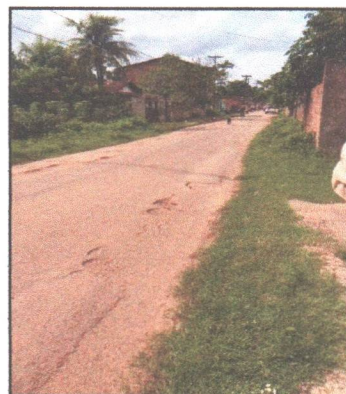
Imagem da rua de acesso ao imóvel com pavimentação asfáltica
